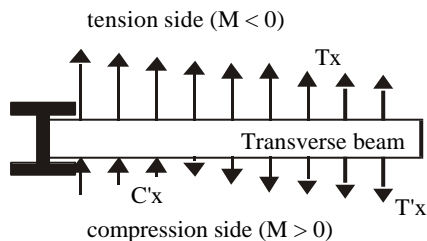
Forces présumées appliquées à la poutre transversale pour les spécimens rigides
